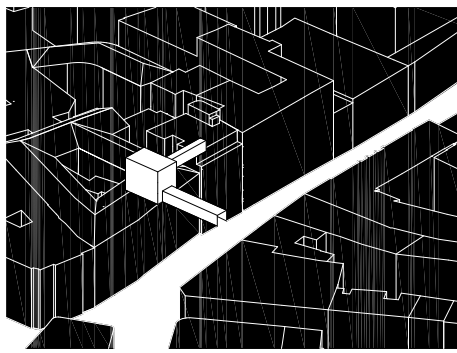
Pasáž paláce U Stýblů 1:2000.
